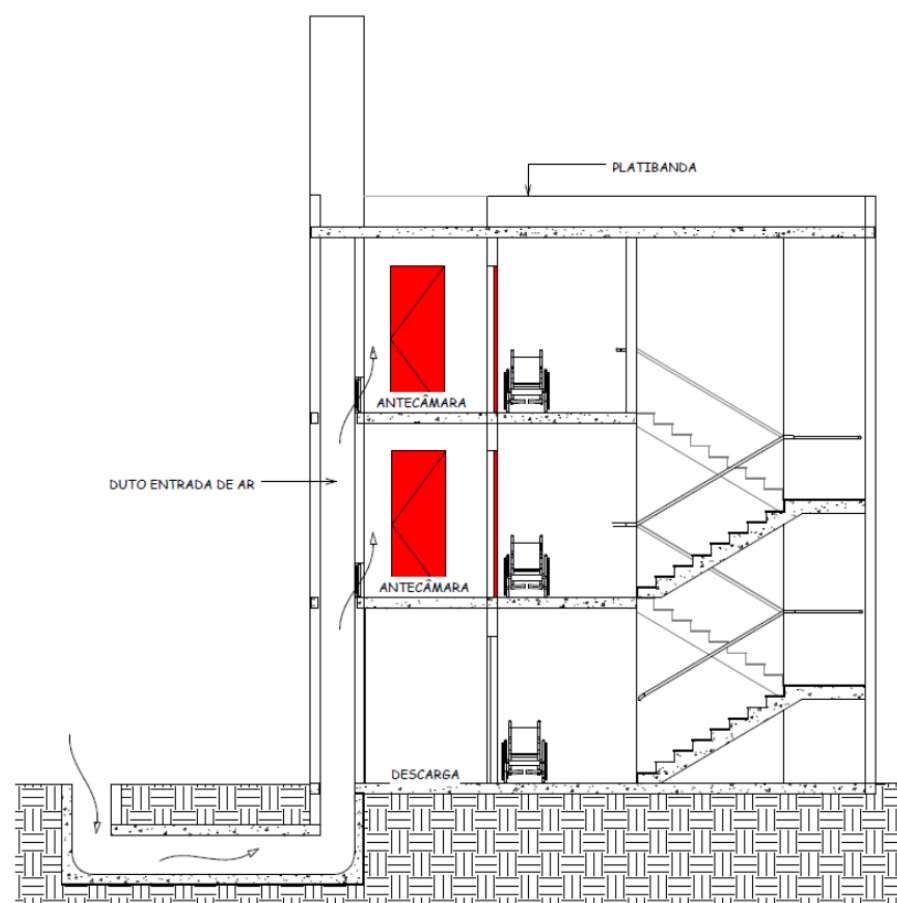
D - Escada à prova de fumaça (corte do duto de entrada).
